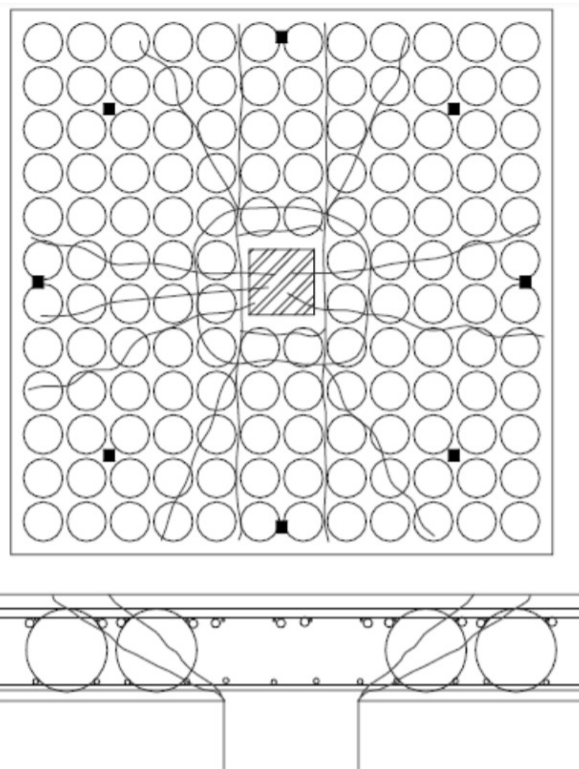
Vista en planta y elevación del agrietamiento por punzonamiento debido a grandes esfuerzos.
